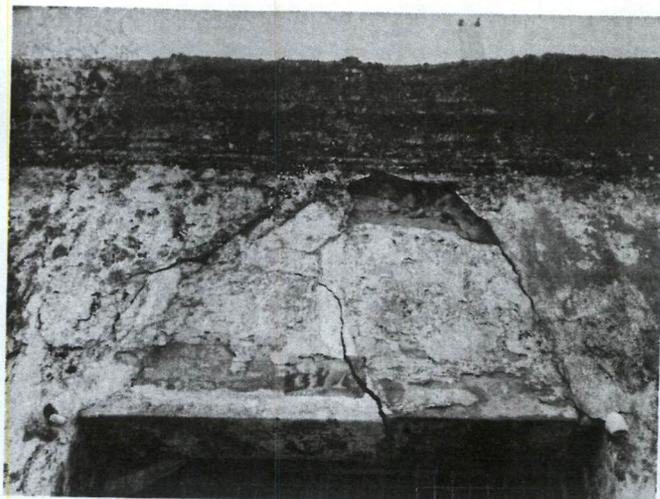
Pormenor de fissuração na padieira da porta no alçado principal
